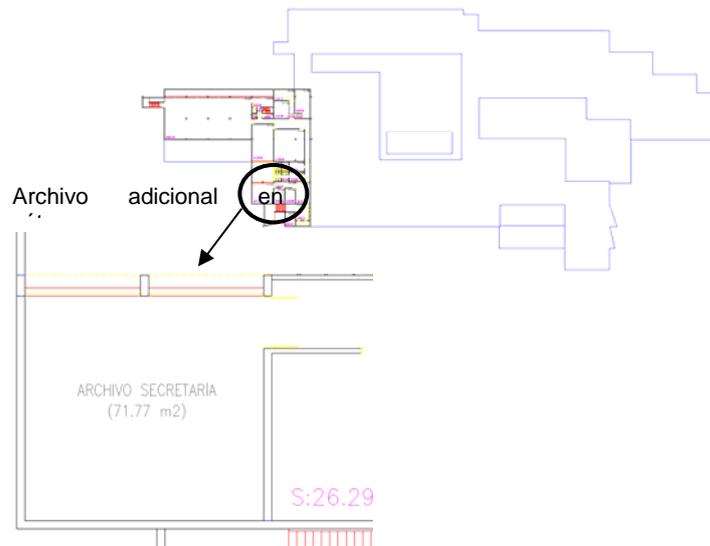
11. Localización y distribución del archivo de secretaría (II) situado en planta sótano
